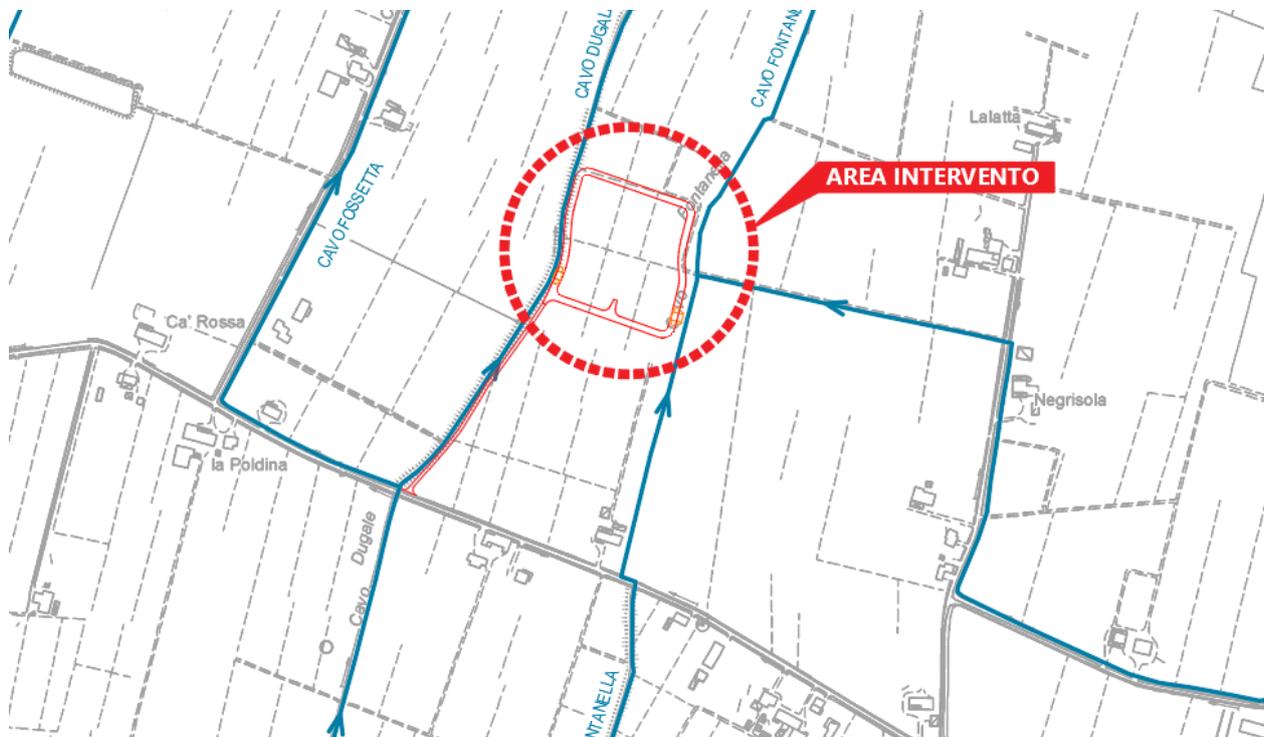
Inquadramento planimetrico dell'intervento in progetto
